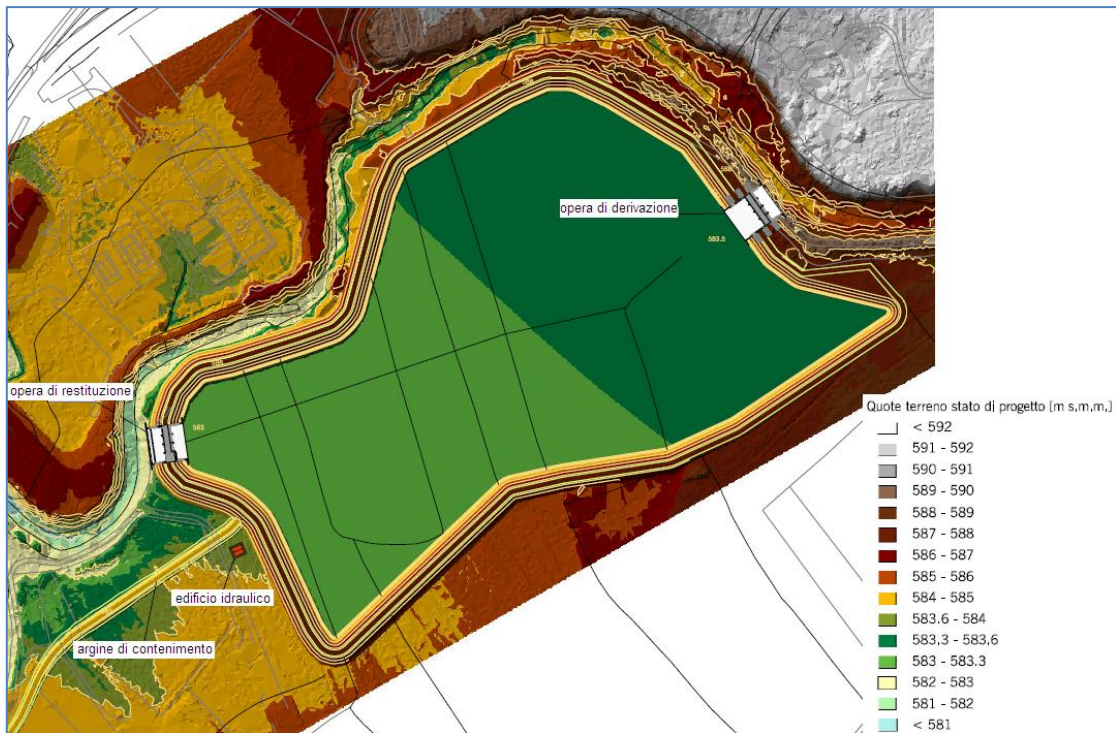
Altimetria del terreno della cassa sul T. Turano nello stato di progetto [m s.m.m.].
